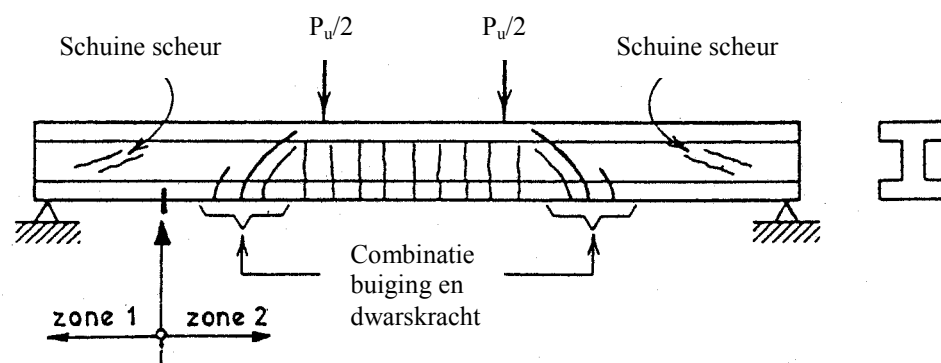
Scheurzones en scheurpatroon in een gewapend en voorgespannen betonelement
